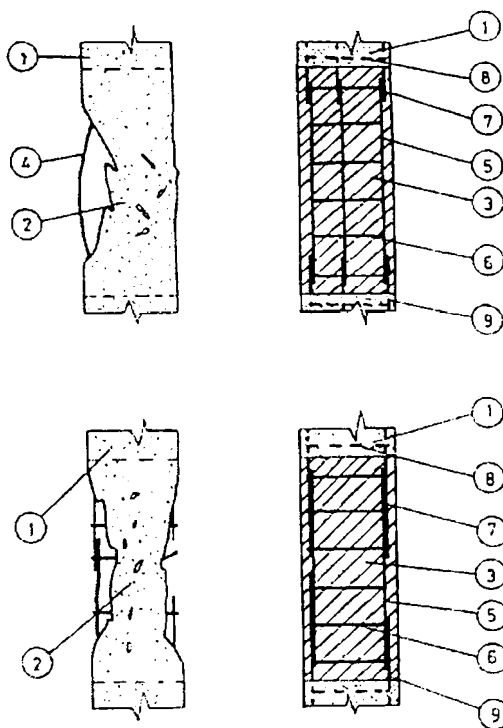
Consolidarea la un stilp puternic avariat , prin adaugarea de armatura si completarea cu beton ;1- beton neavariat in stilp ;2- beton existent avariat ;3-beton nou ;4- armatura flambata ;5- armatura noua ;6-etrieri noi ;7-sudura ;8-etrieri existenti ;9- armatura existenta .
